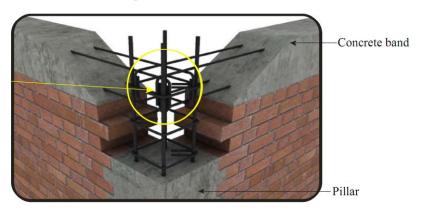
Расположение железобетонной колонны в теле кладки (рекомендации Пакистана)
